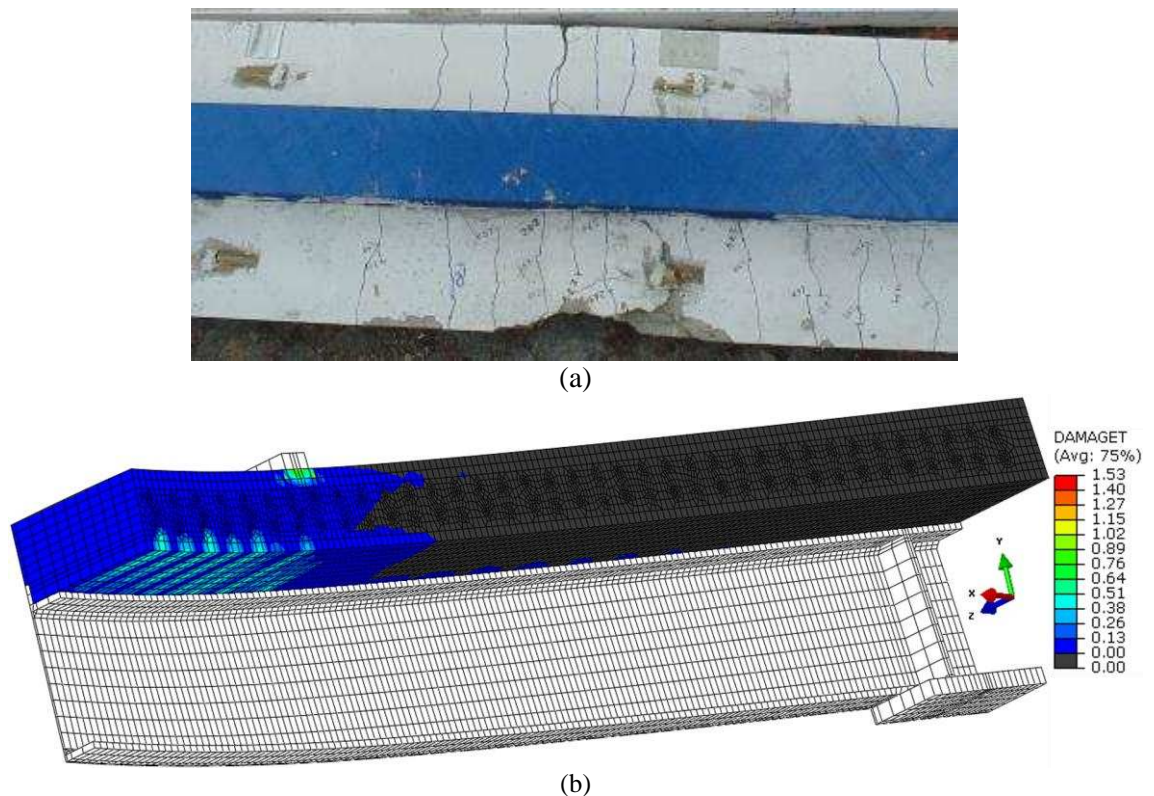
Fissuração na face inferior da laje de concreto na ruptura: (a) vista inferior da *VM_Crest_1*; (b) modelo numérico desenvolvido.
